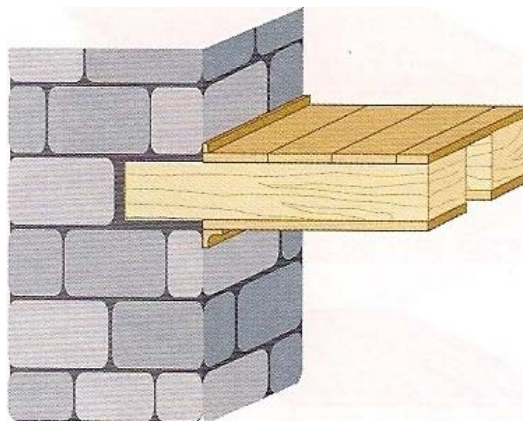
Ligação pavimento-parede de alvenaria [1].
